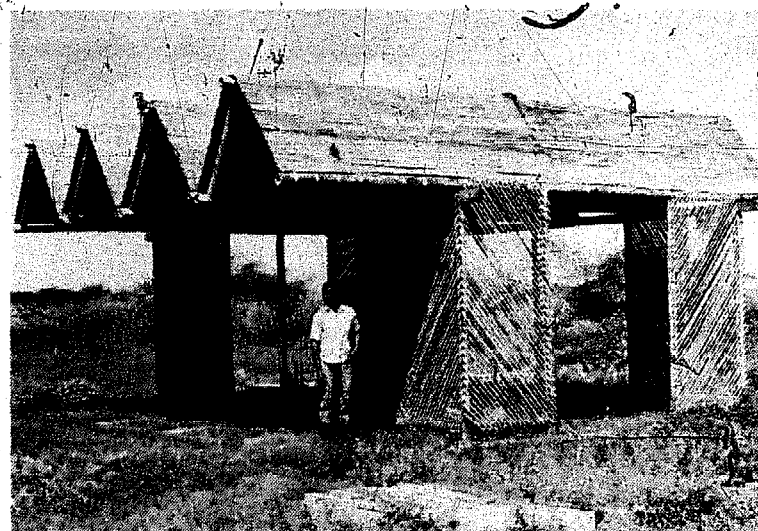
Para probar la rigidez de las armaduras, inicialmente se dejaron con un voladizo de 2.25 metros.
